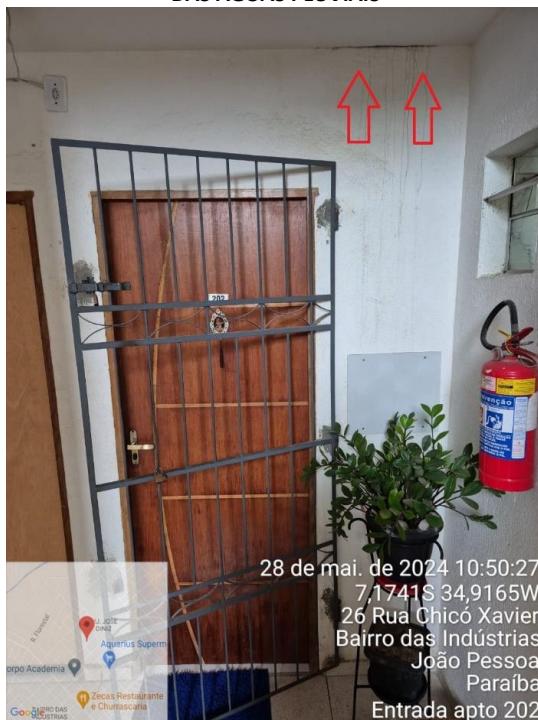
INFILTRAÇÃO NA ENTRADA DO APARTAMENTO
